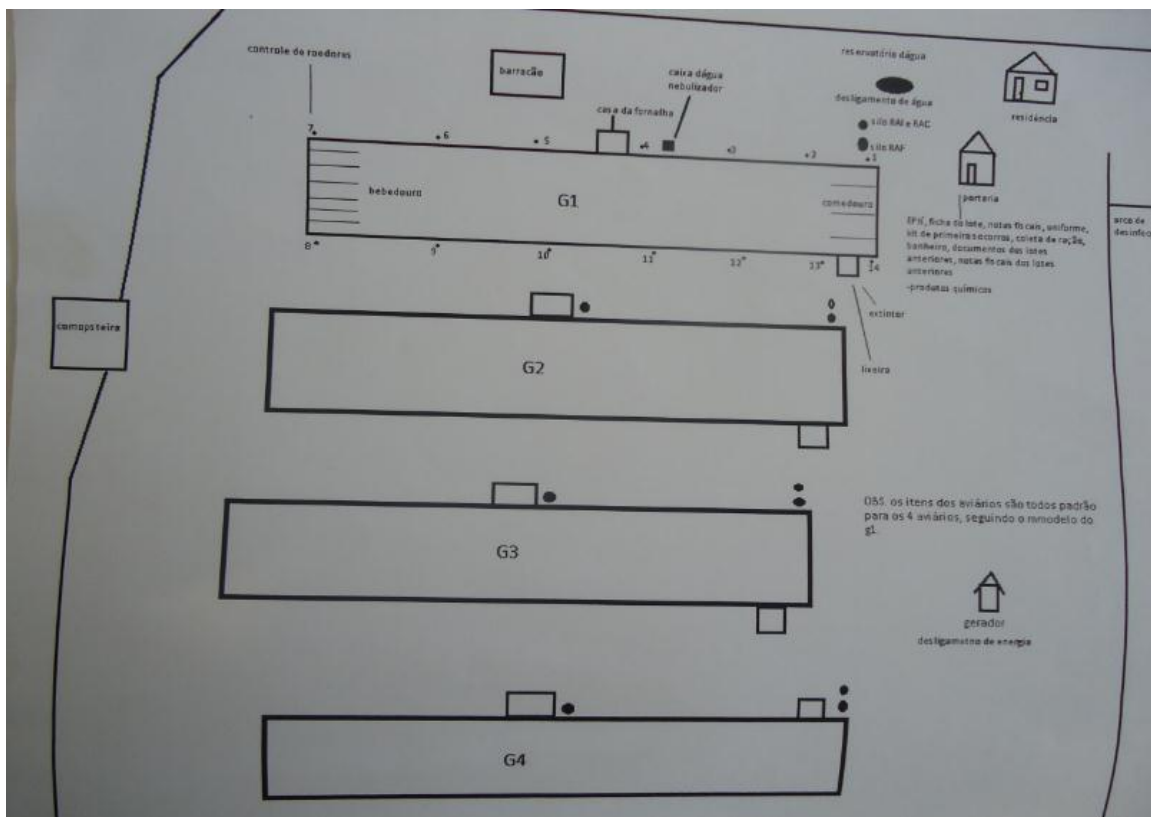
Planta Baixa da Granja Luvillas Fonte: Granja Luvillas
